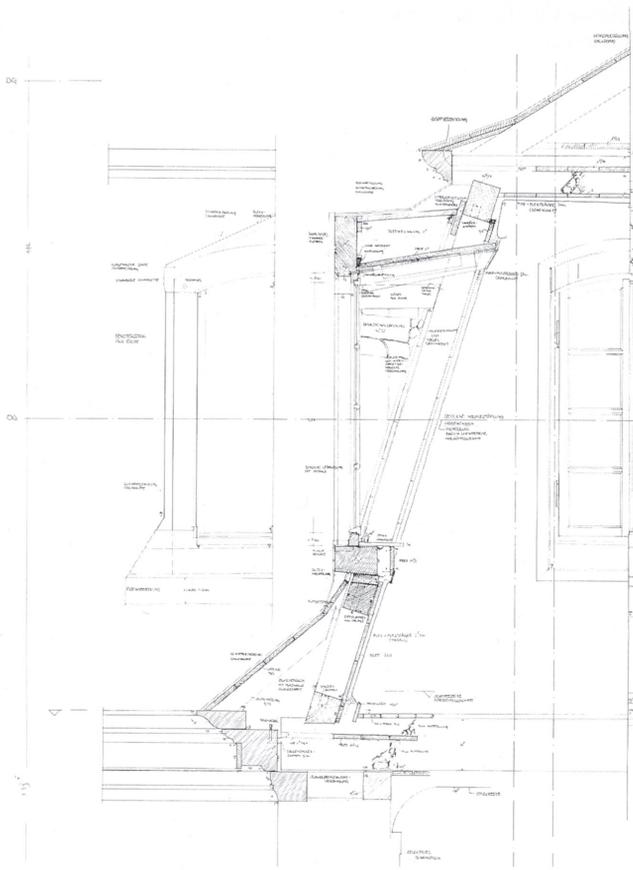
Schloss Braunshardt bei Darmstadt: Detailschnitt durch Dachkonstruktion/Gaube, M 1:10, Ausschnittvergrößerung: aufwendige Bestandsdokumentation zur Klärung komplizierter Konstruktionspunkte (Zeichnung: Stefan Hassenzahl, 1987).
